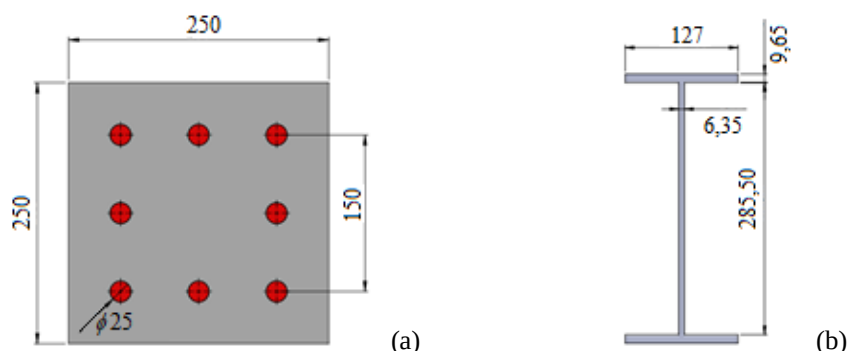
Seções: (a) colunas de concreto armado, (b) vigas e diagonais metálicas (dimensões em milímetro).
